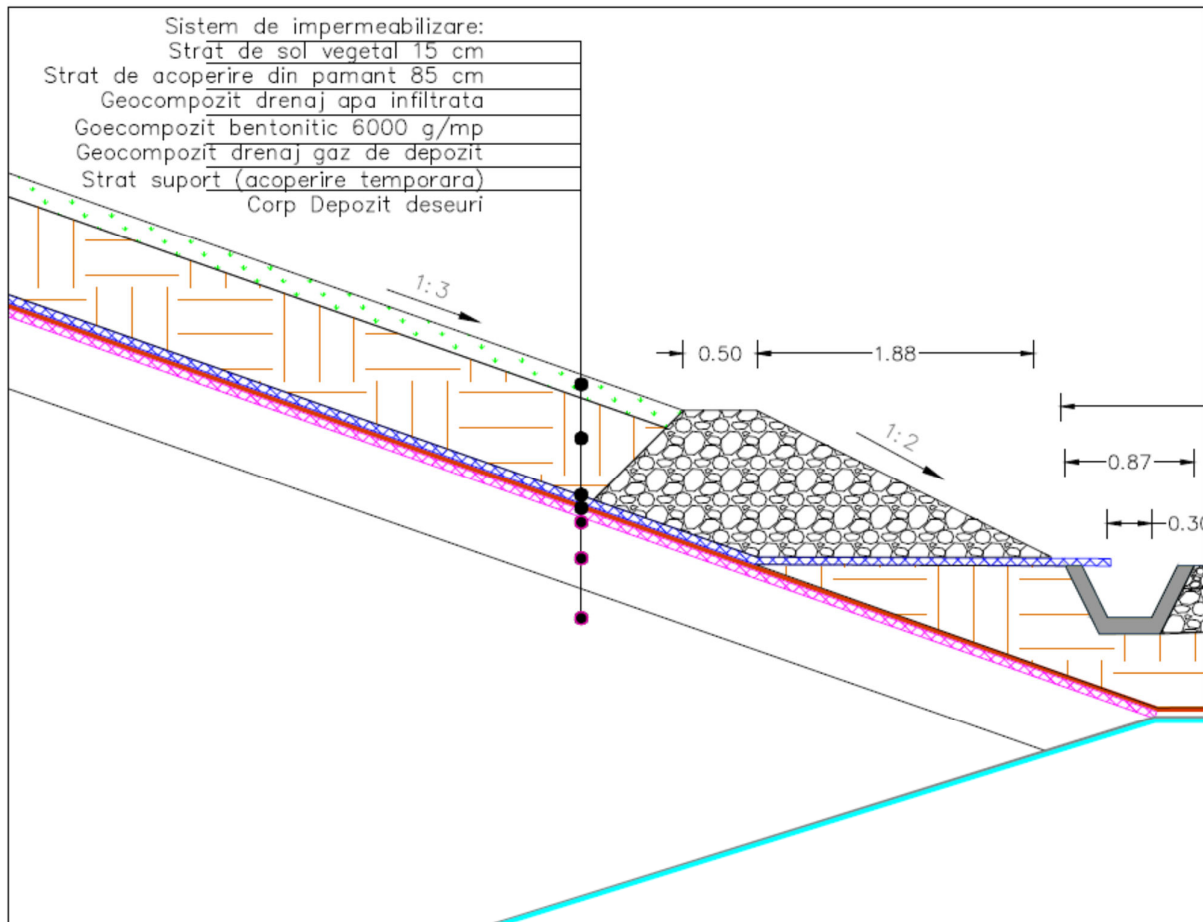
Drenarea apei pluviale infiltrate prin stratul de acoperire în rigola perimetrală
